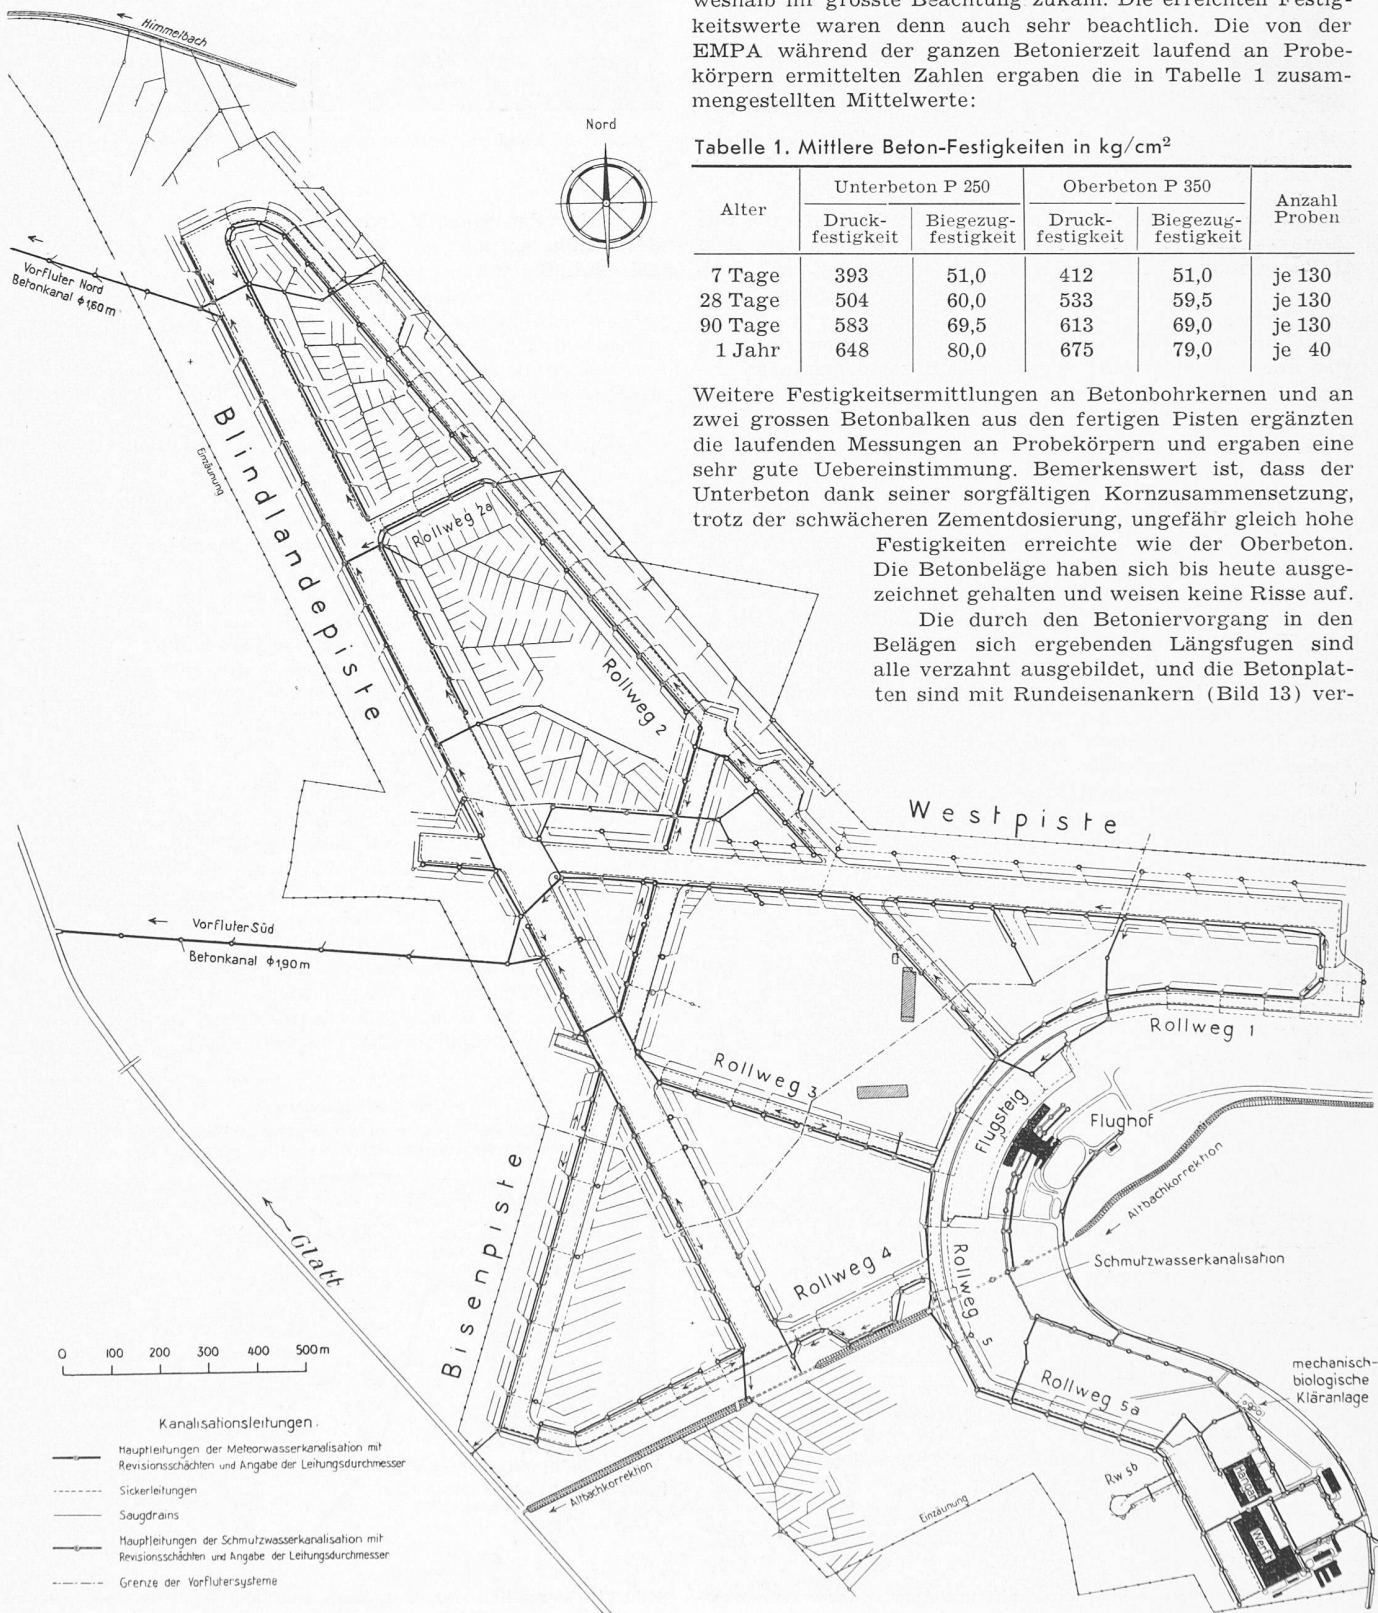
Flughafen Zürich-Kloten, Ubersichtsplan der Entwässerungsanlagen, Masstab 1:15 000
